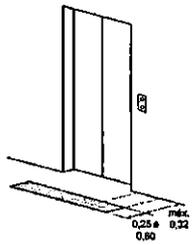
Sinalização tátil de alerta junto à porta de elevador — Exemplo
